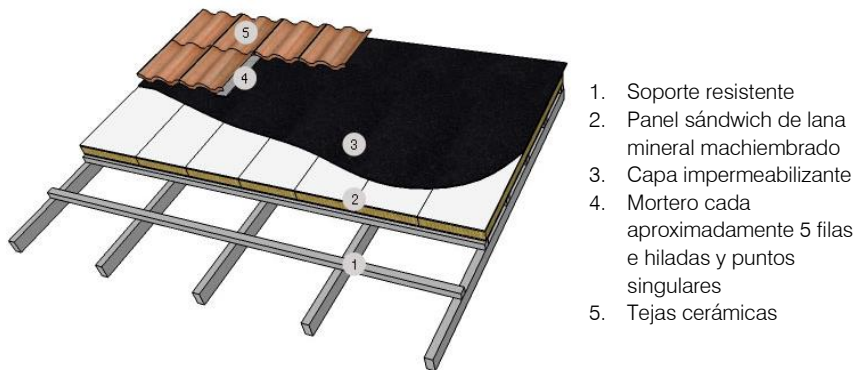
Esquema de cubierta con paneles sándwich. Aislamiento por encima de forjado
